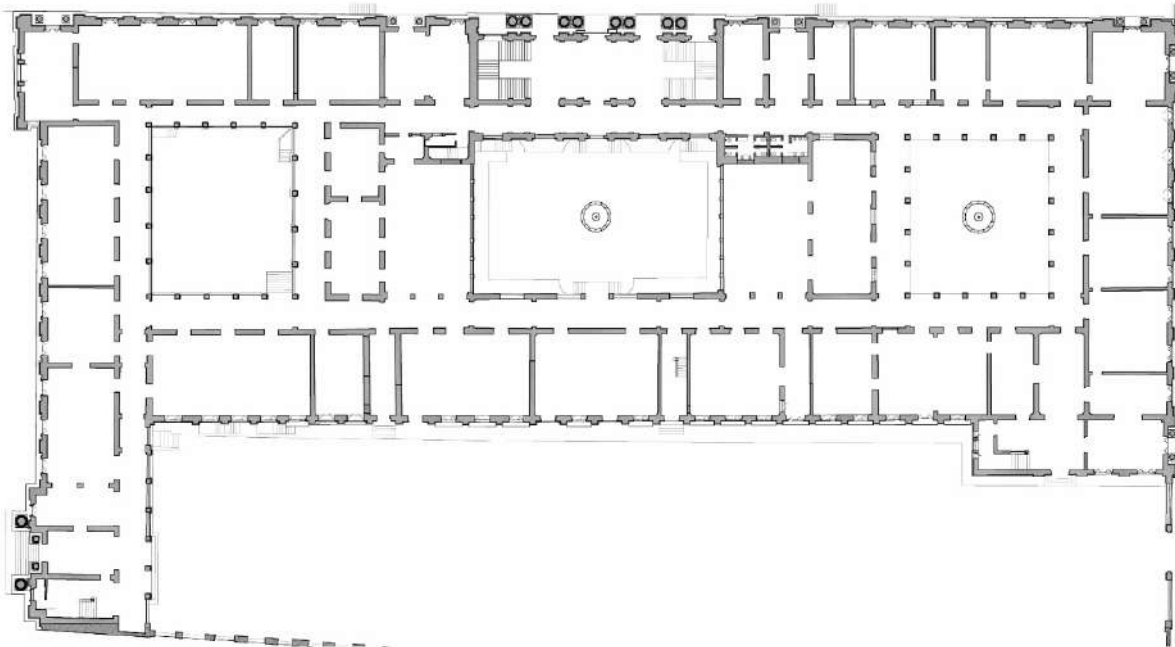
Planta de primer Segundo piso con circulaciones y accesos
